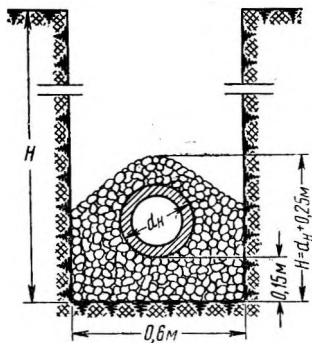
Схема укладки дренажных труб в относительно плотных грунтах.
